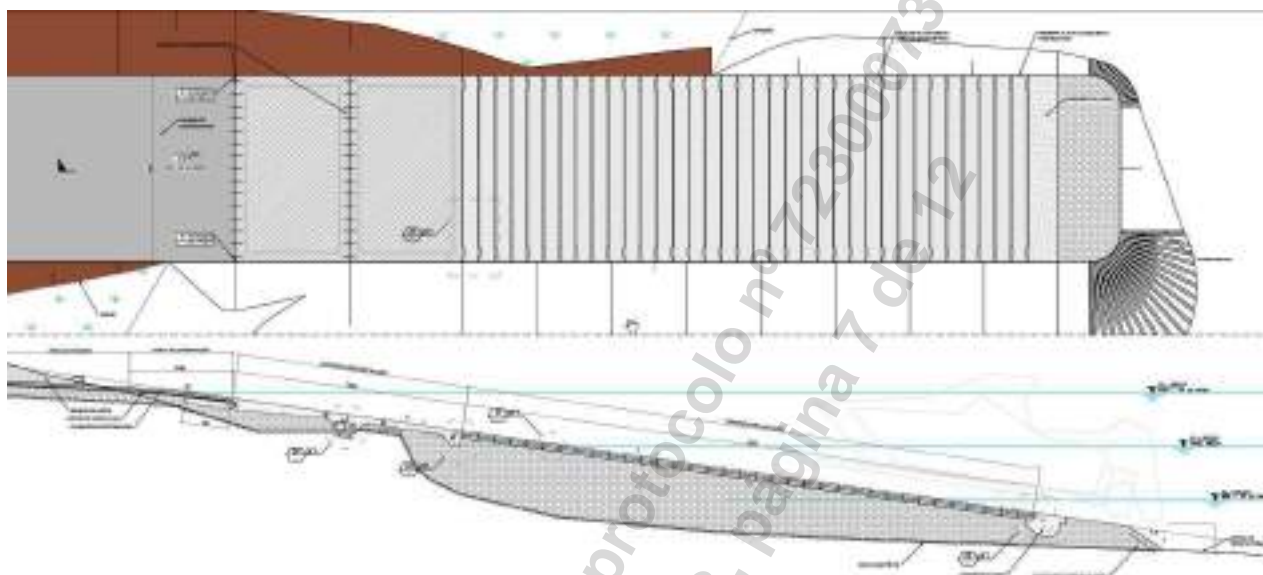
Planta e seção transversal – Rampa de acesso de embarcações
